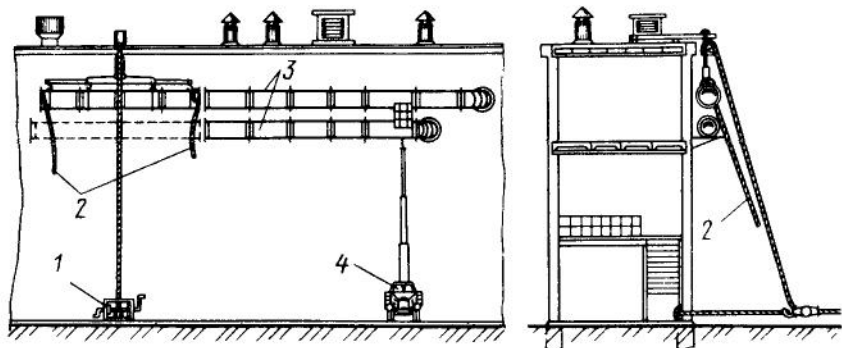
Монтаж горизонтальных воздуховодов на наружной стене:
